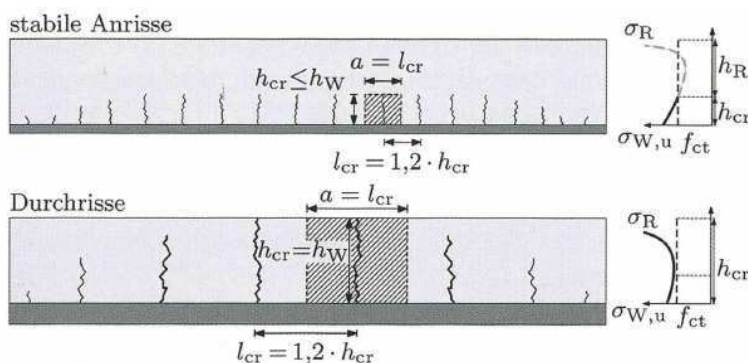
Abstand der Primarrisse bei Wänden auf Fundamenten
